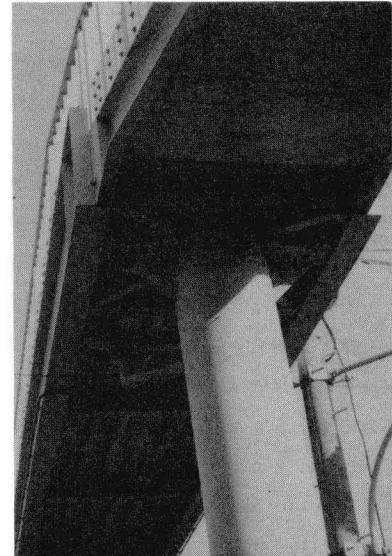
横断歩道橋(例-1)床ゲタ・デラキプレート・支柱
